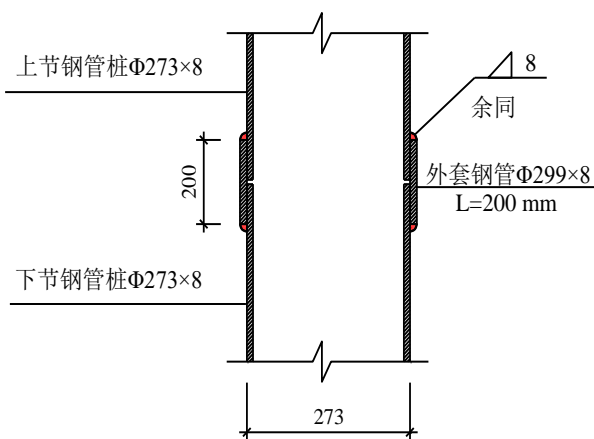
锚杆静压桩接桩施工工艺 (单位: mm)
